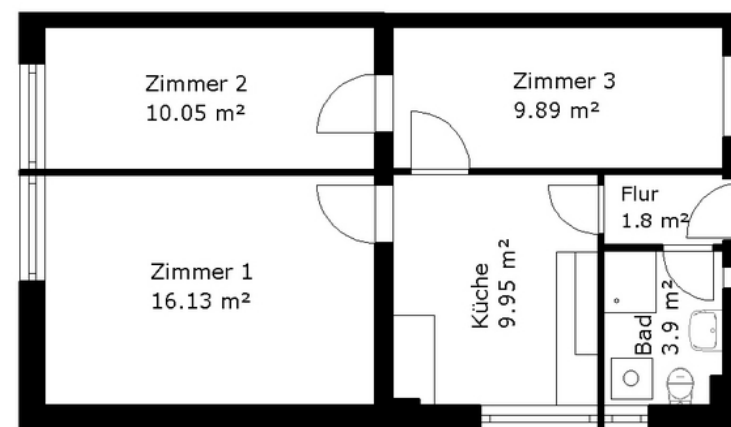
Grundriss mit Gefangenenzimmern
